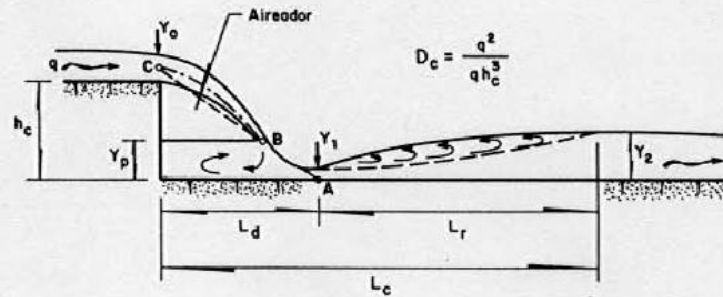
Geometría del flujo en las estructuras de caída [5]
